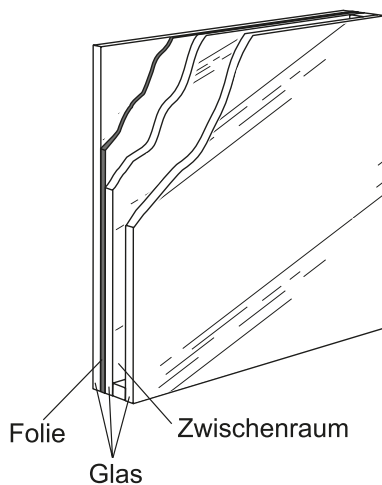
Aufbauprinzip einer einbruchhemmenden Verglasung
